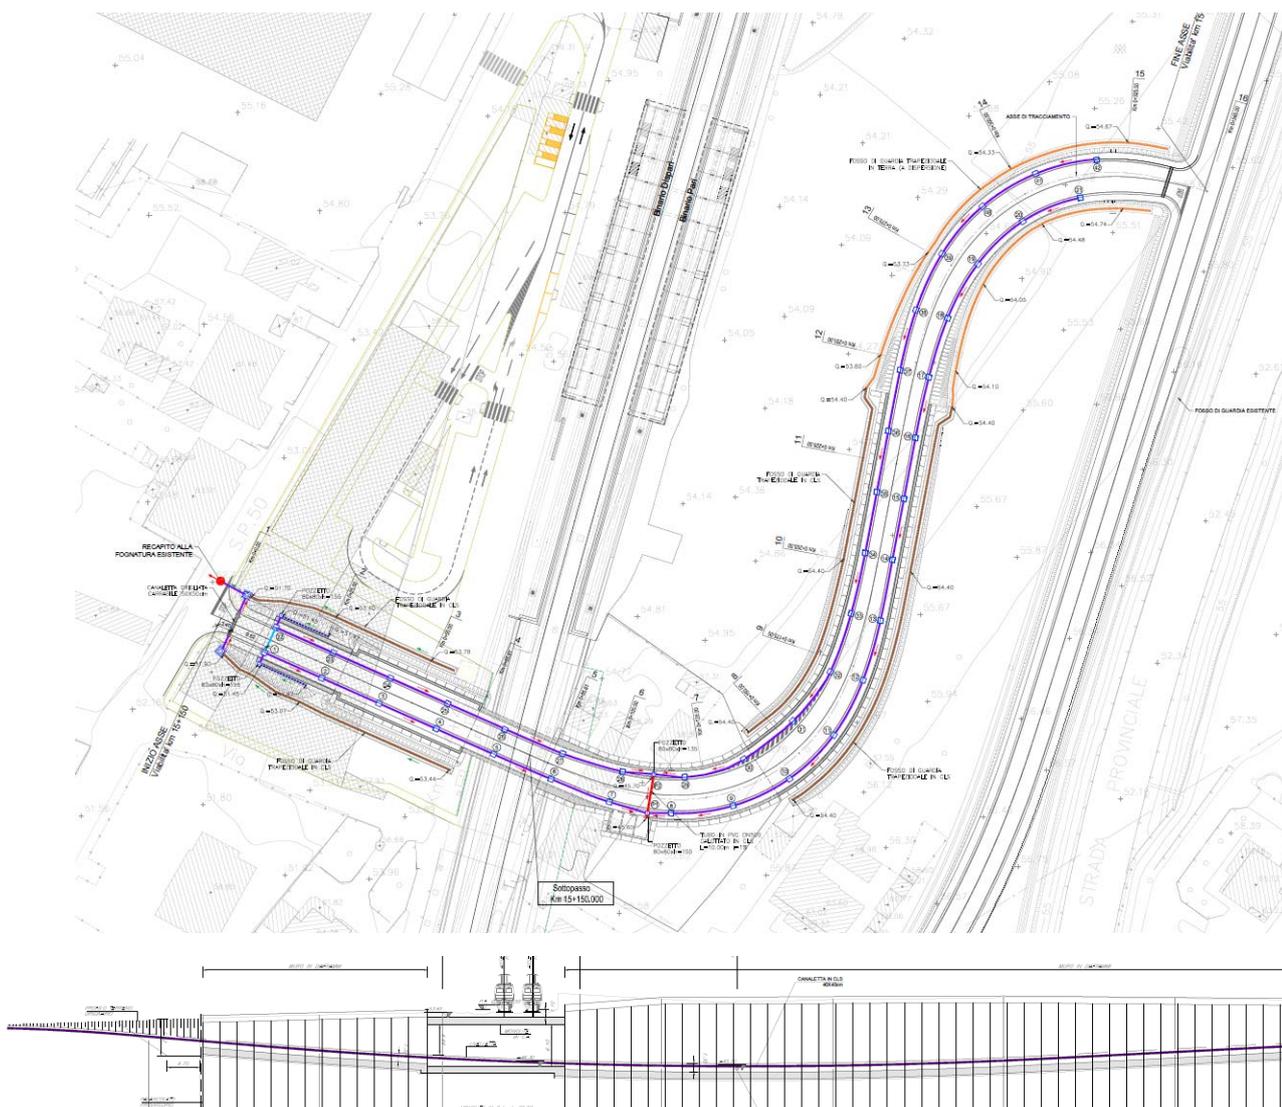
Planimetria e profilo del sottovia della Stazione di Dugenta.
